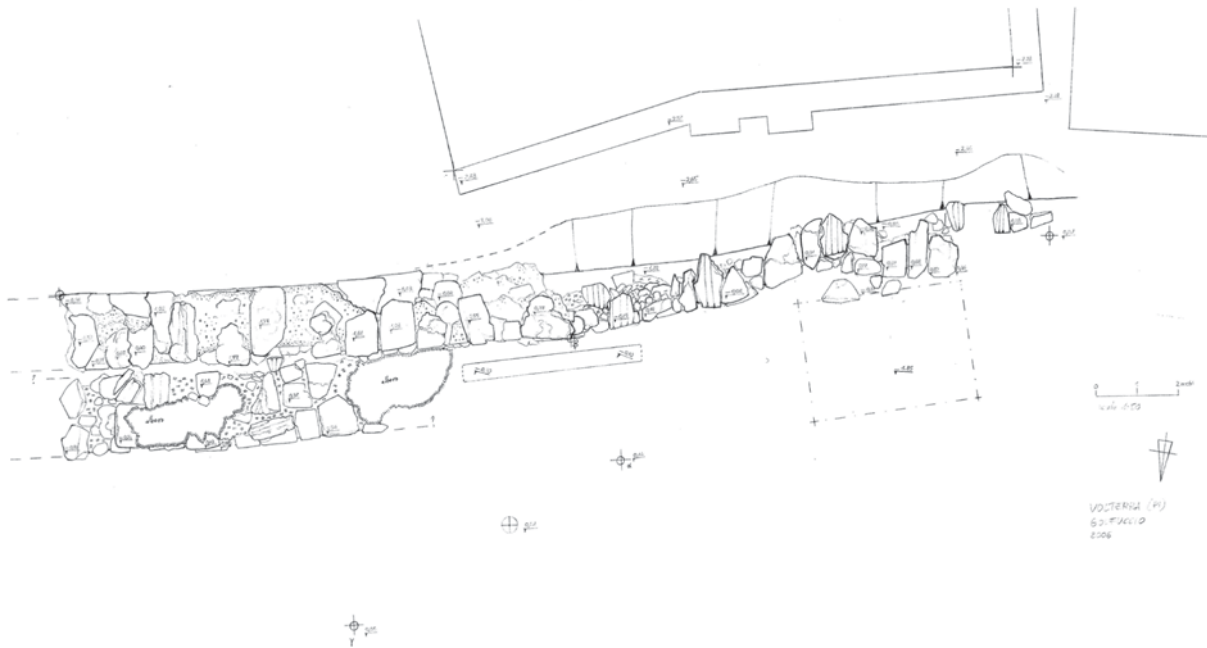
Golfuccio – pianta del tratto murario prima del crollo.
